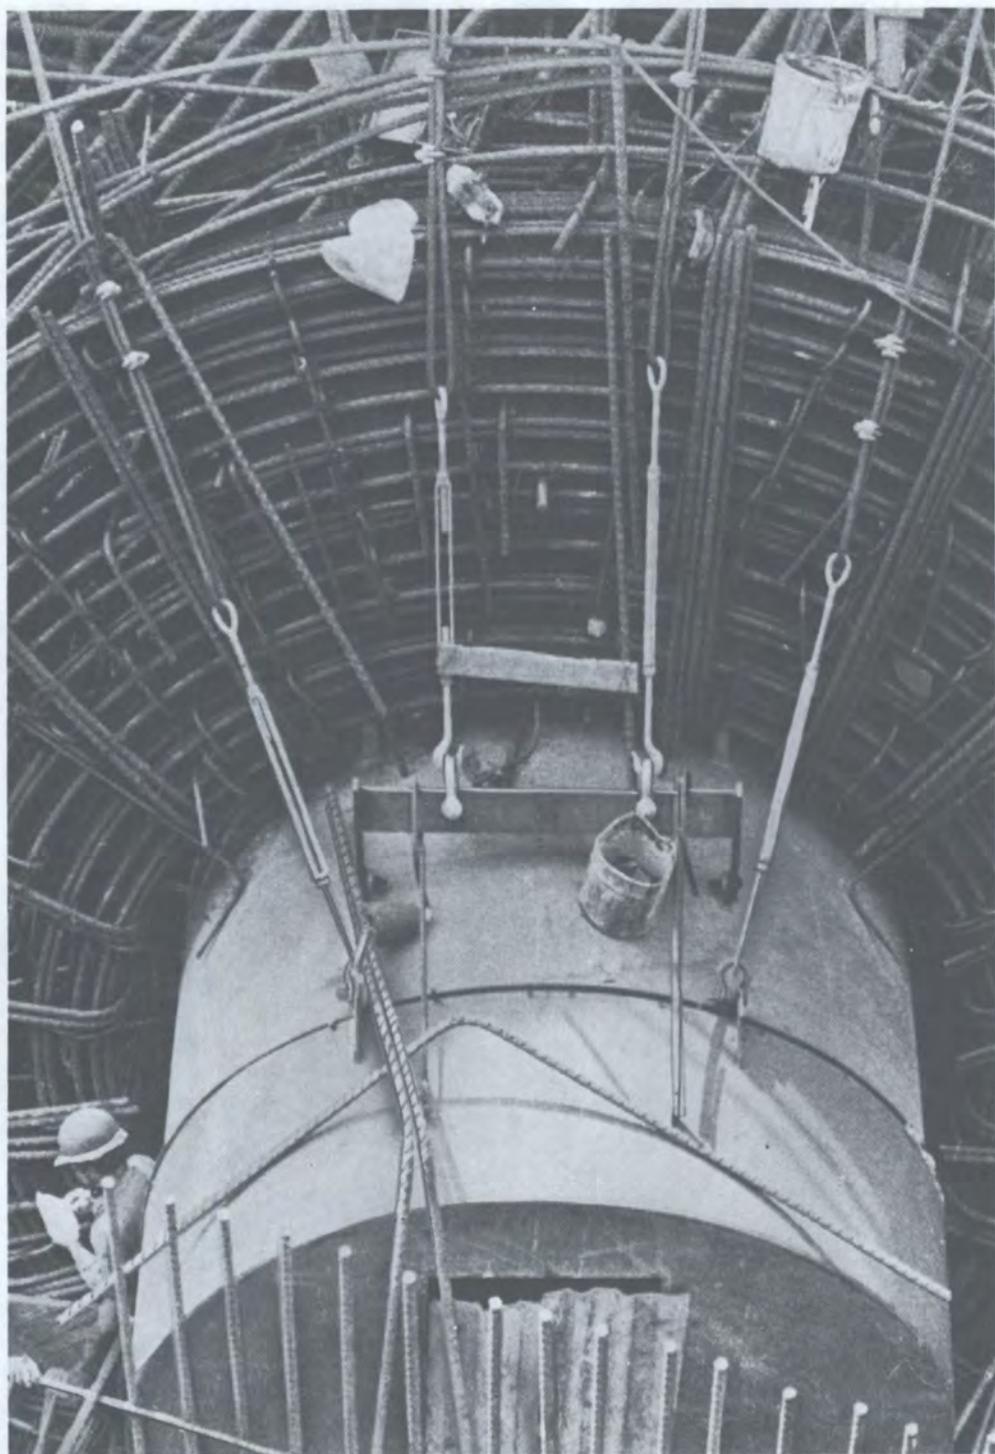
, 7, 8. Монтаж дополнительного арматурного пояса вокруг шлюза для временного входа персонала.
